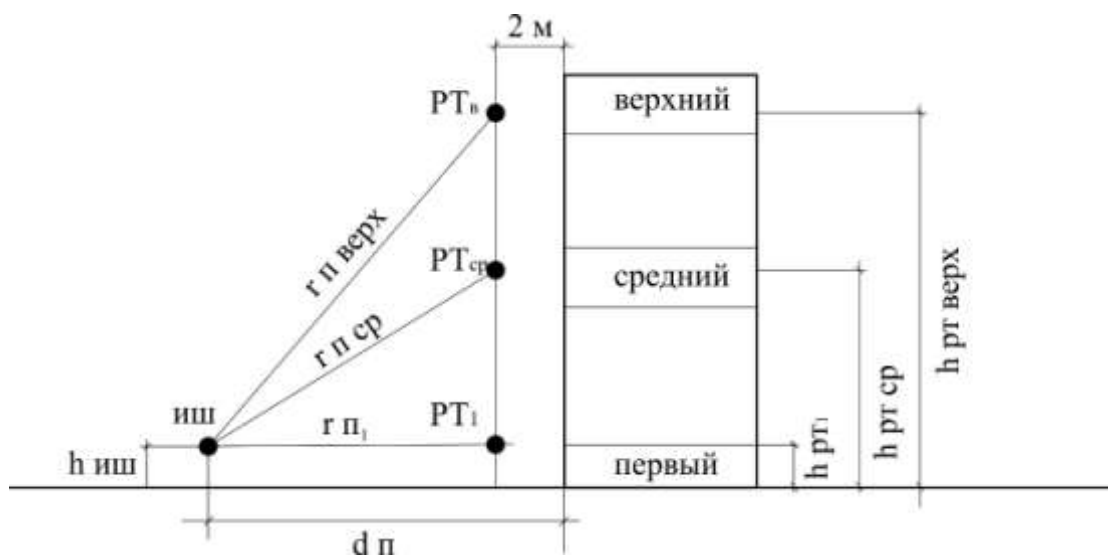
Расчетная схема для определения уровня звука у фасадов зданий
